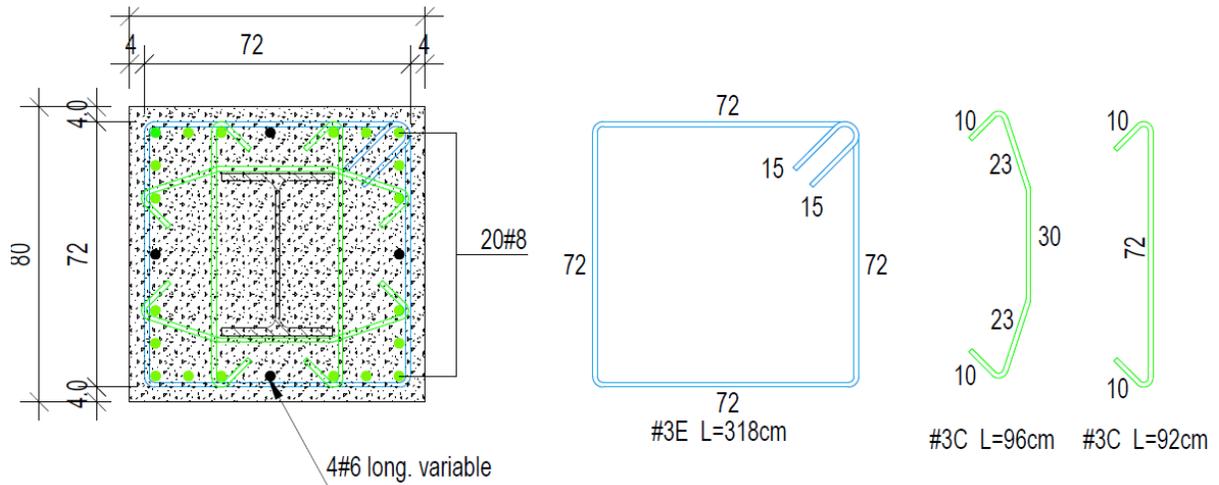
Refuerzo transversal de las columnas 70 x 70 en los nudos.
